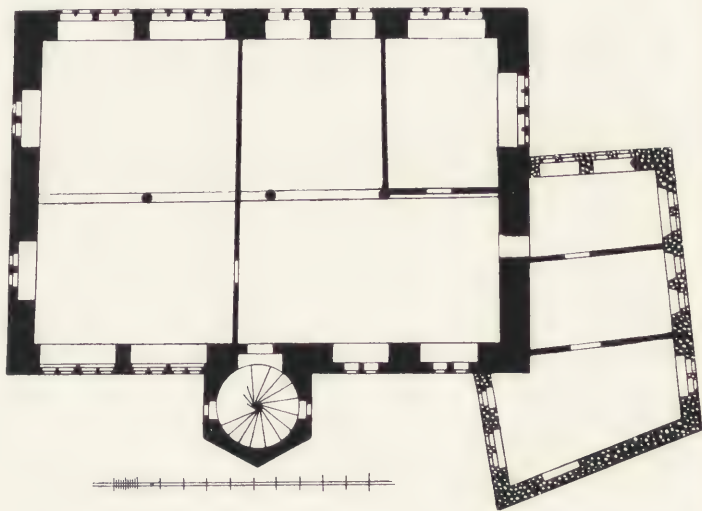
Rathaus zu Marburg. Grundriß des ersten Stockwerks. Nach Aufnahme des Stadtbauamtes.
